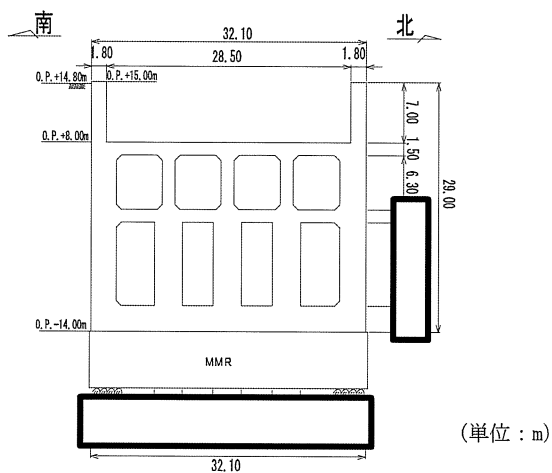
第 3 号機海水ポンプ室断面図 (A-A 断面)
